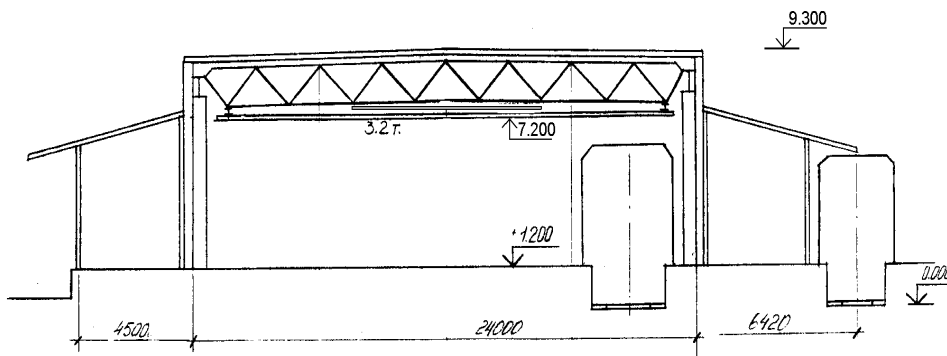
Предлагаемое решение– сталежелезобетонные панели покрытия (серия 1.065-9.1)
